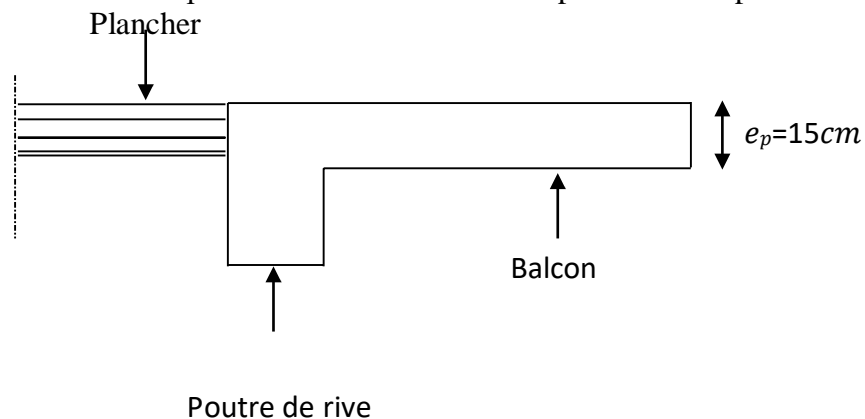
Coupe verticale détaillant la liaison balcon – poutre.
